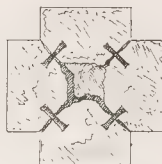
Piano superiore dell'abaco di un capitello di piliere isolato, coll'indicazione delle chiavette di collegamento.
